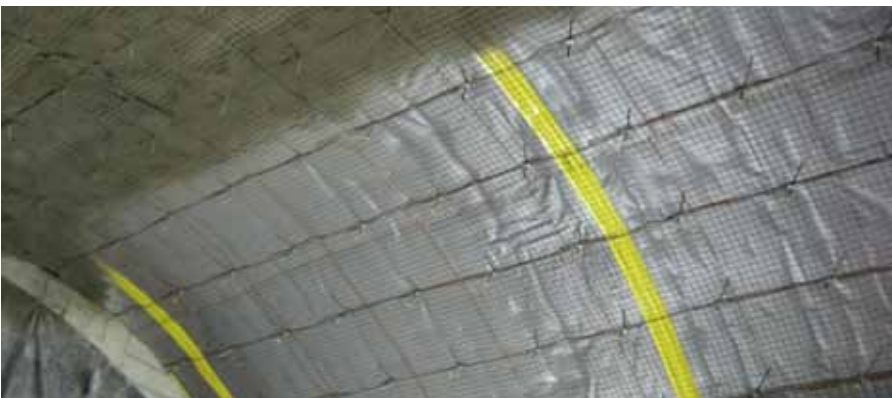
Cubrimiento del Sikaplan® con hormigón proyectado
